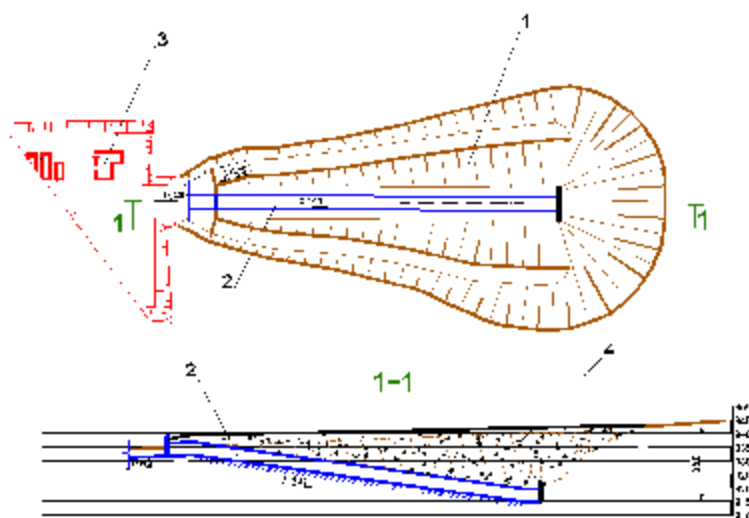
План и разрез въездной траншеи и протяженной железобетонной устьевой части наклонного ствола №5-Г на руднике Гужумсай: 1 – траншея; 2 – железобетонная устьевая часть ствола, построенная открытым способом; 3 – здания промплощадки; 4 – грунт обратной засыпки
